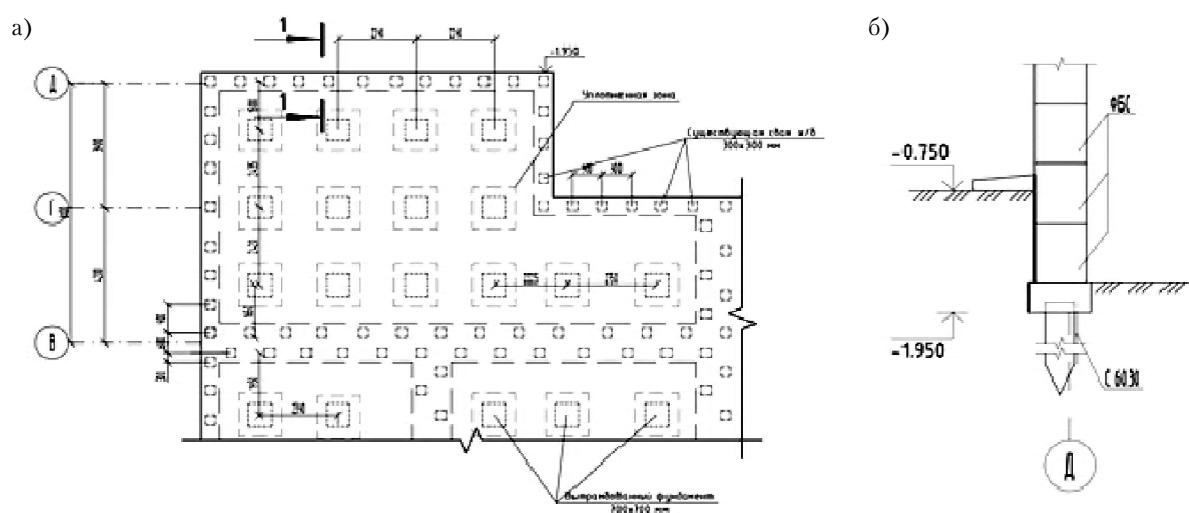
Устройство вытрамбованных фундаментов в существующем свайном поле: а) фрагмент плана устройства вытрамбованных фундаментов; б) разрез 1–1.
